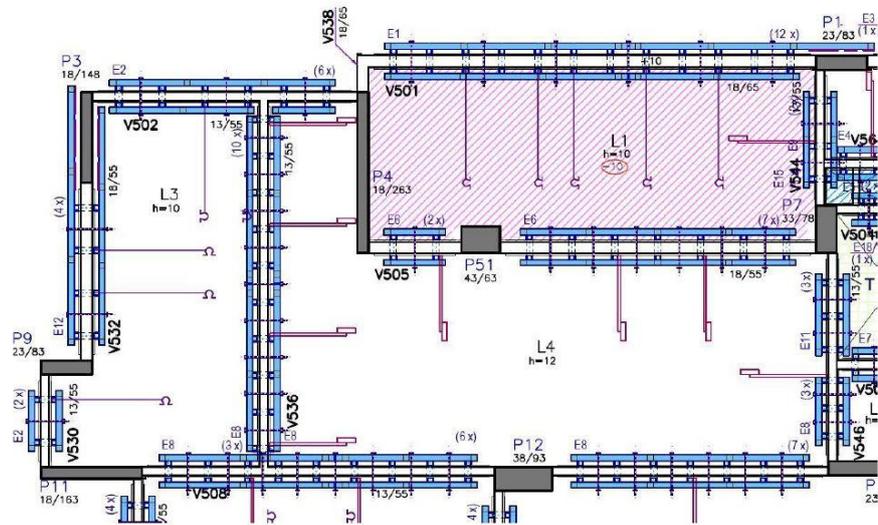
Planta de montagem, distribuição e travamento das escoras
